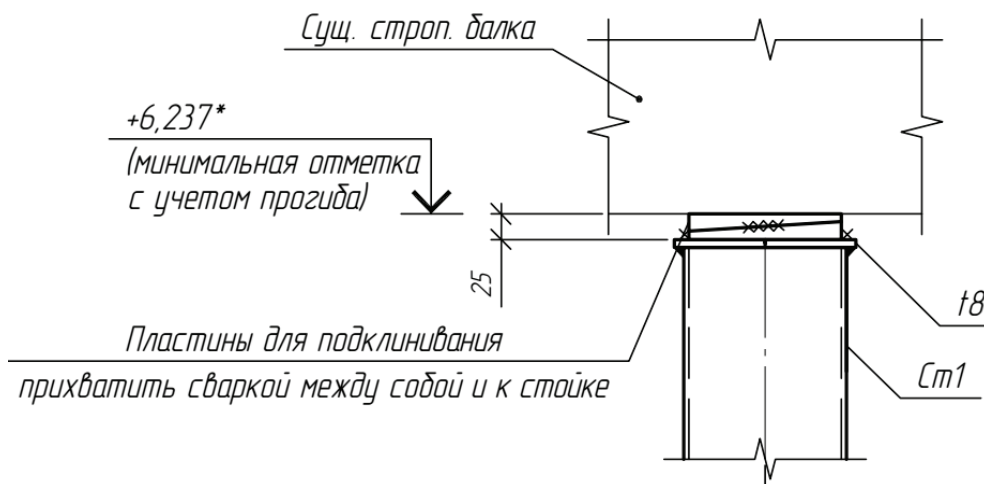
Узел подклинивания стойки для включения в совместную работу со стропильной балкой
